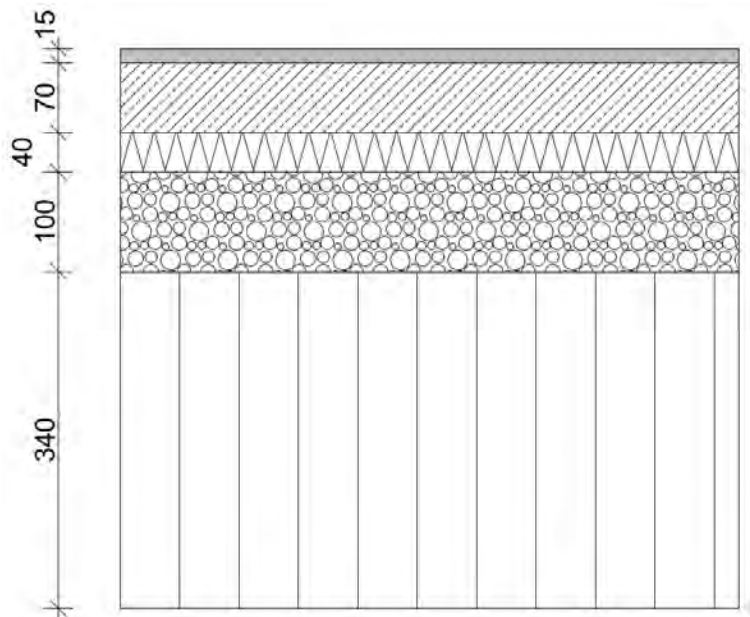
Schema Deckenaufbau Massivholzdecke
